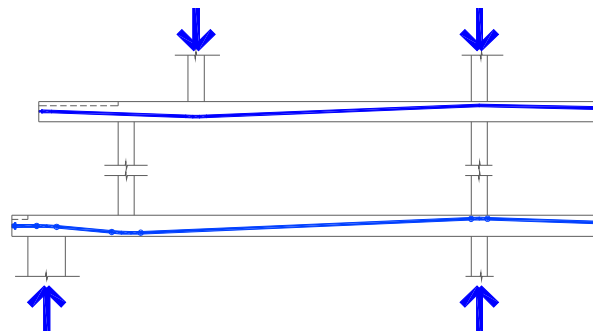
Corte demonstrativo do recuo da fachada e esquema do traçado de cabos utilizado
